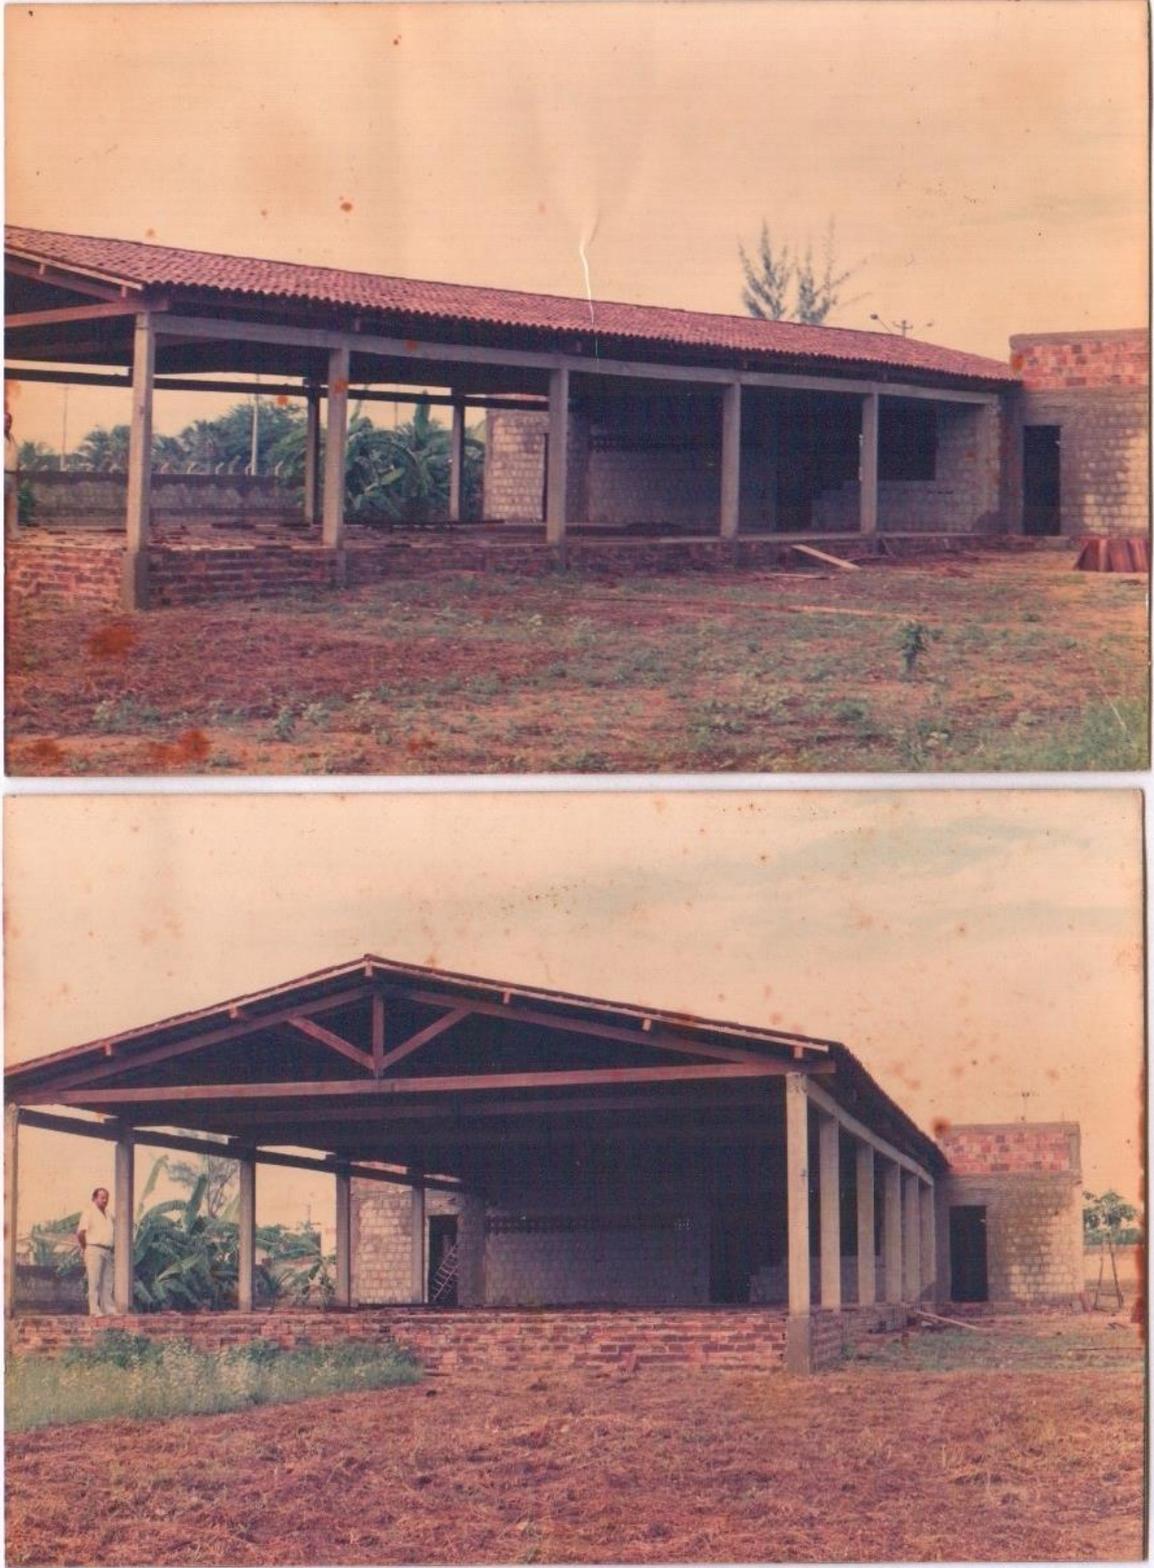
Terreno doado pelo Prefeito Jerônimo Dix-Huit Rosado/Início de construção da sede própria
